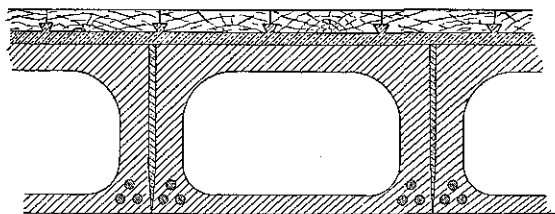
Præfabrikeret jernbetondæk udviklet i Schweiz - »System Siegart« (L. af Petersens: »Jærnbetong i moderna Bjälklag«, 1908).
